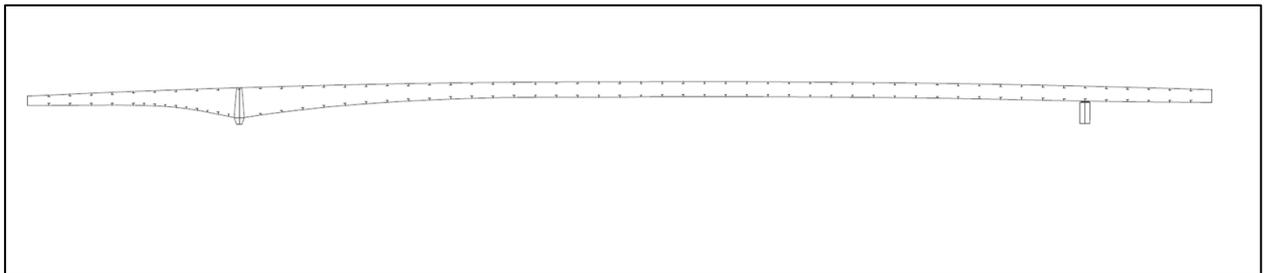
plano sección transversal con posición de marcos rigidizadores
